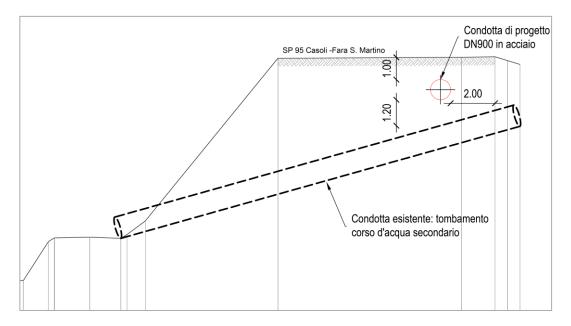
Sezione longitudinale attraversamento di progetto sul Fosso 2.
